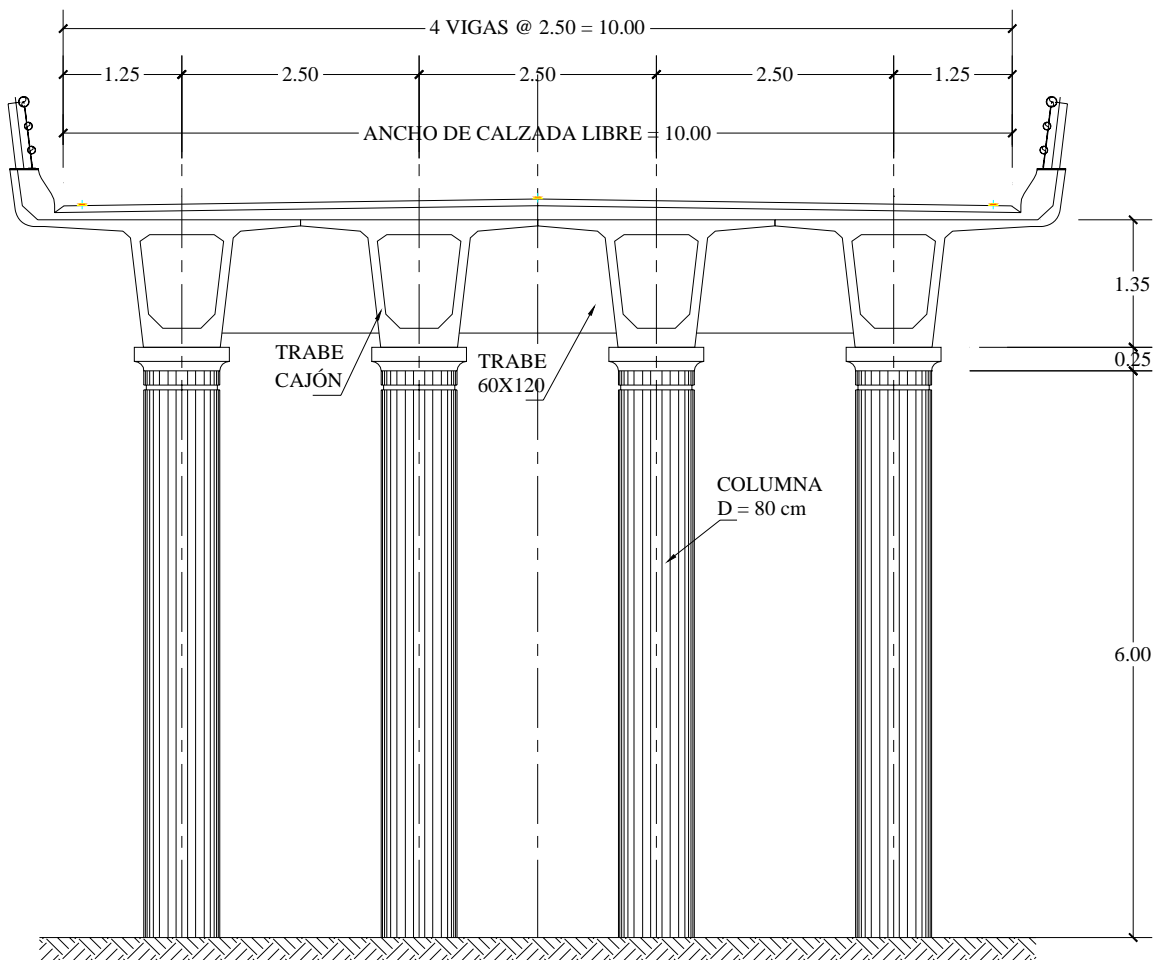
Sección transversal con 4 columnas puente urbano, eje B
